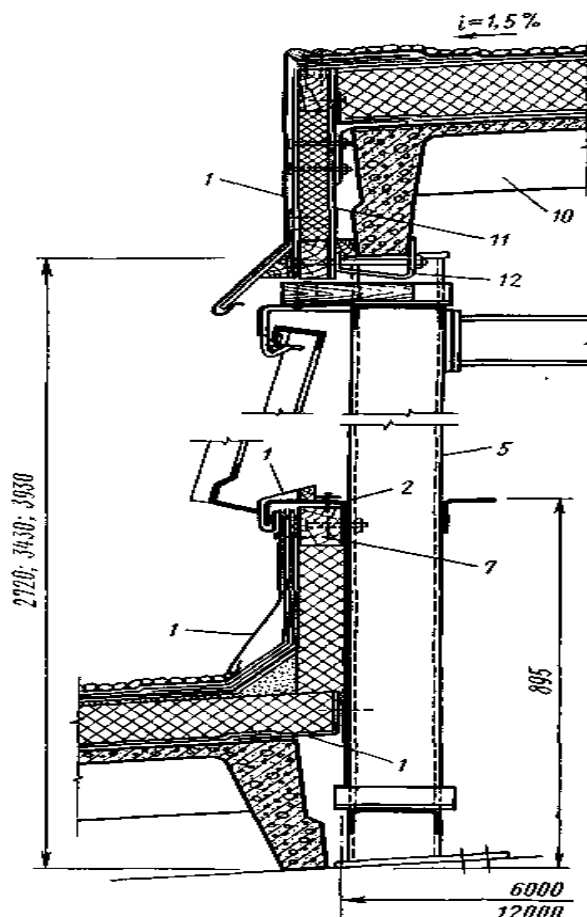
Конструктивные детали прямоугольных фонарей: при покрытии из железобетонных плит: 1 - кровельная оцинкованная сталь; 2 – швеллеры; 3 – профилированный настил; 4 – фонарная ферма; 5 – фонарная панель; 6 – переплет; 7 – деревянные бруски; 8 – асбестоцементные или стальные волнистые листы; 9 – противопожарная заглушка; 10 – железобетонная плита; 11 – асбестоцементная карнизная панель; 12 – крепежный анкер
